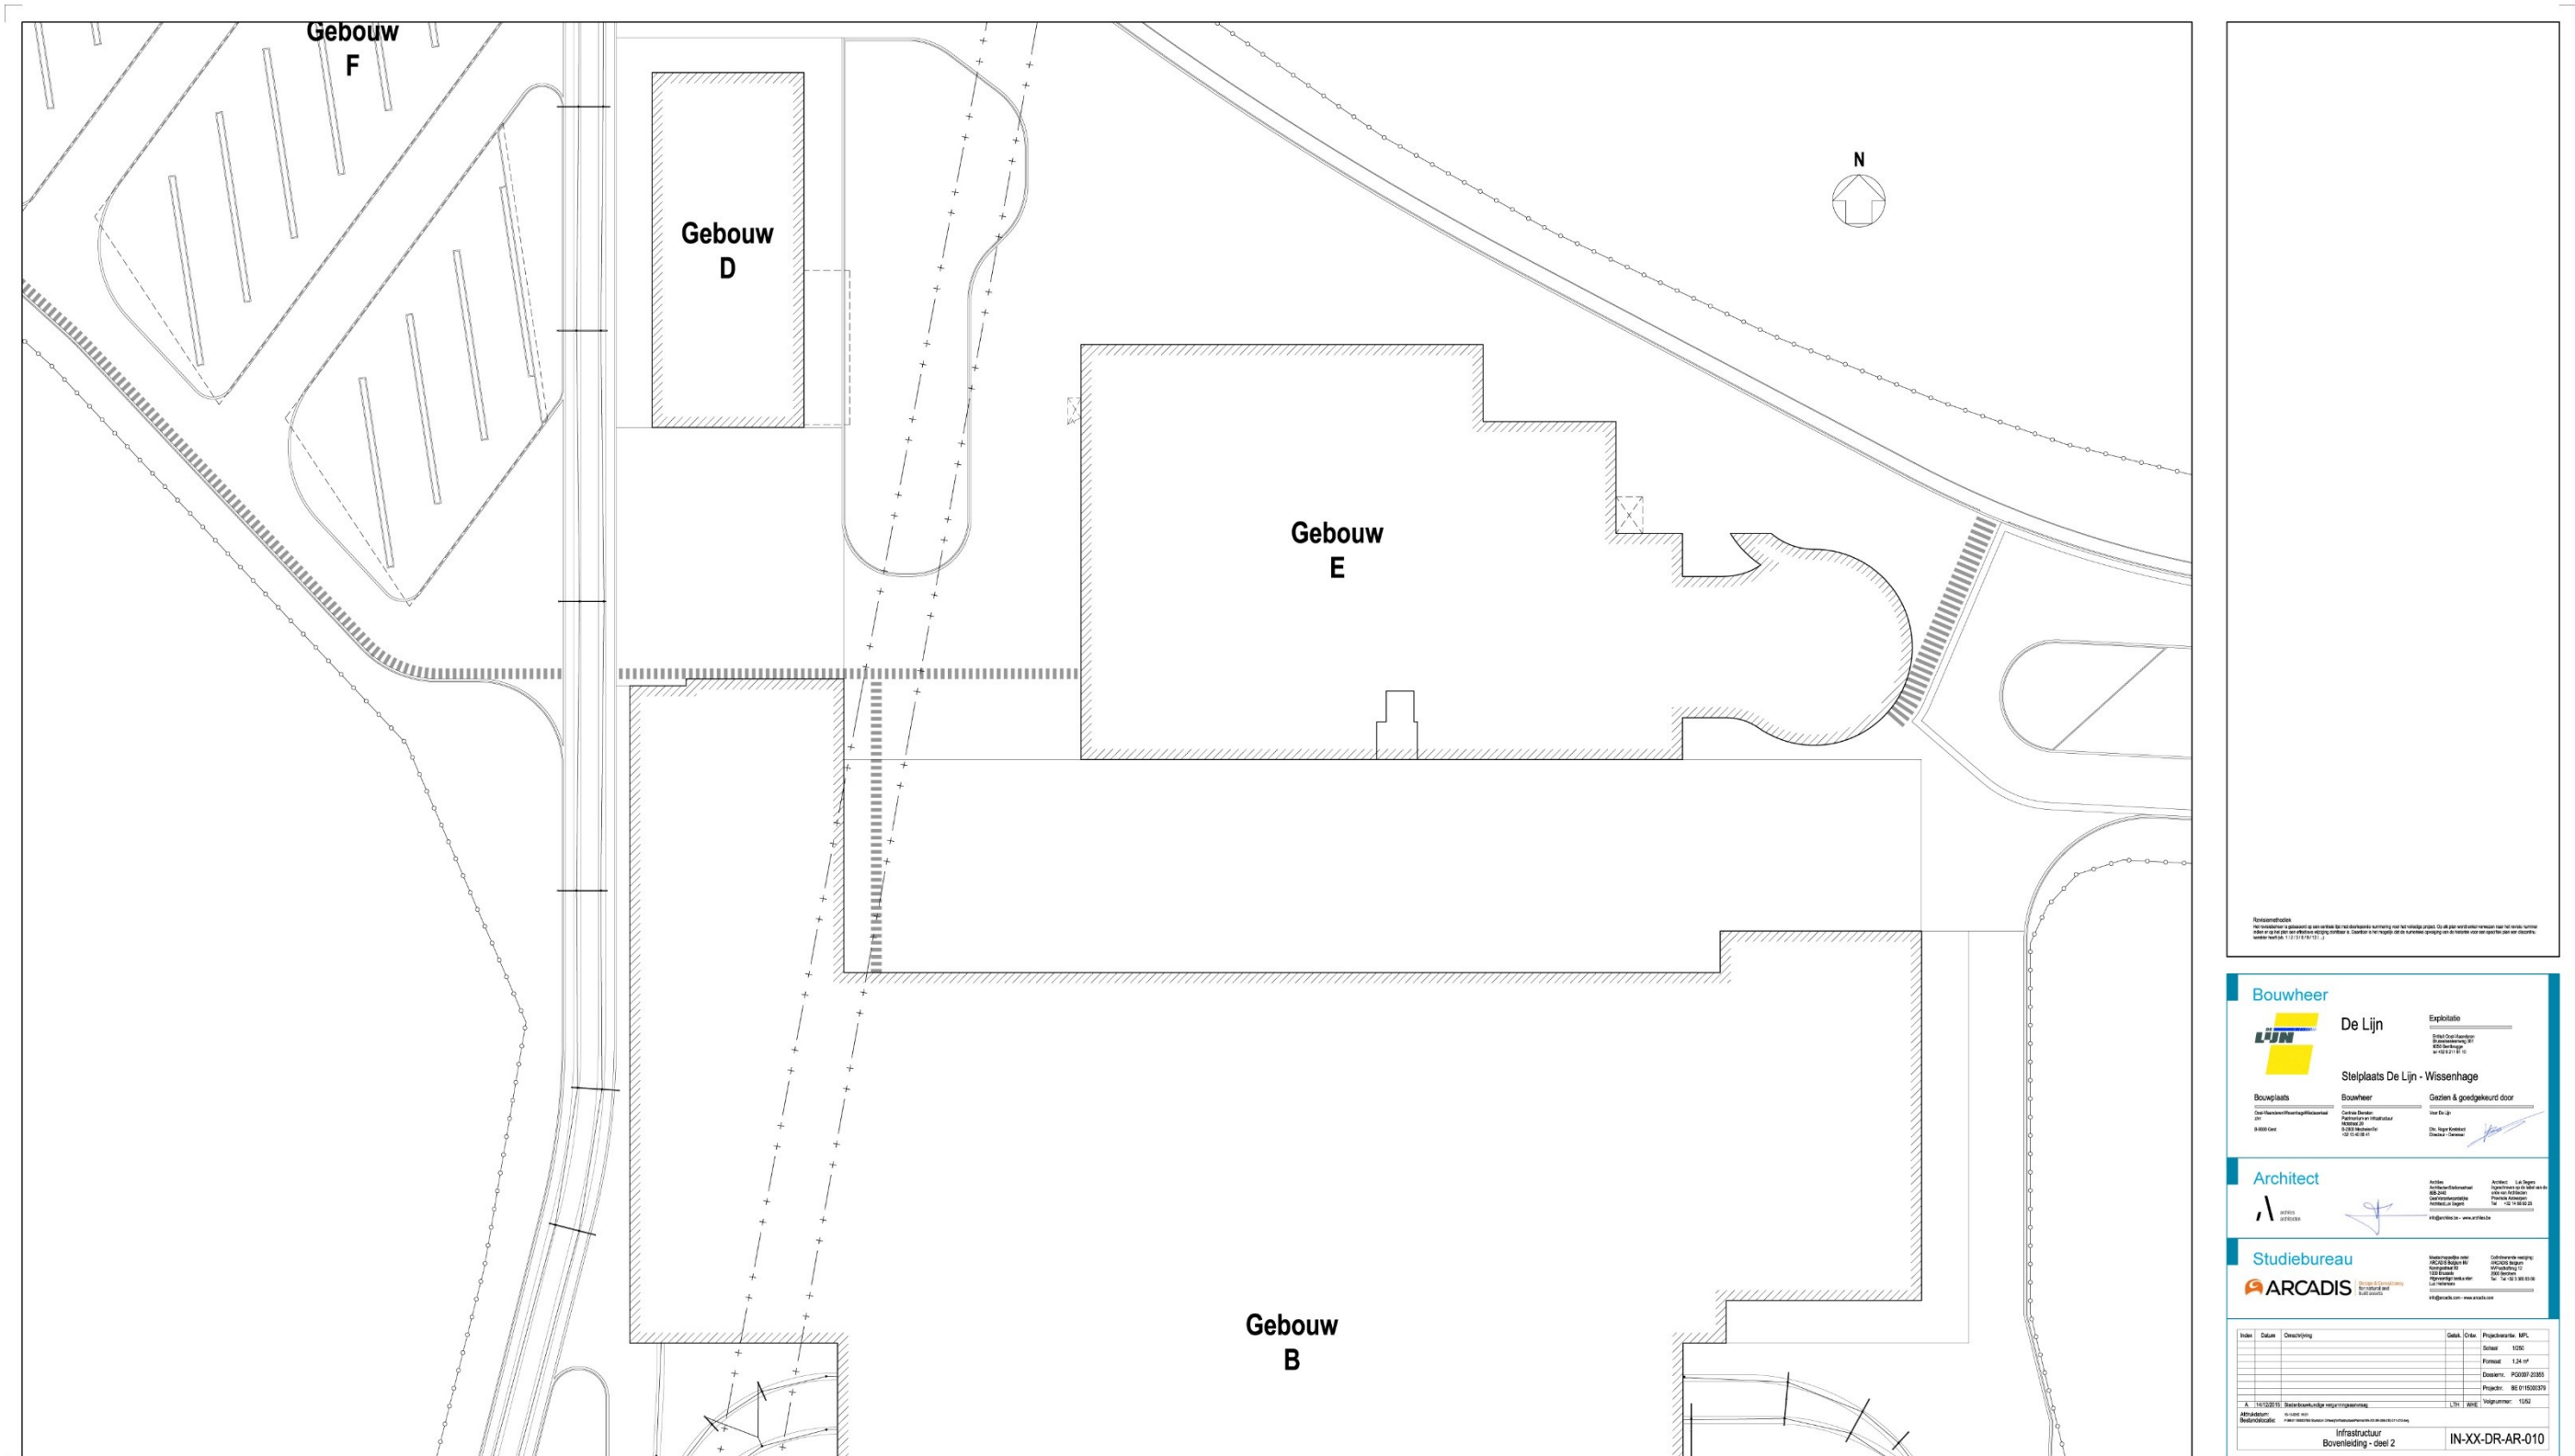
Inplantingsplan met saneringen Fase 1 en 2 (Archiles architecten)
